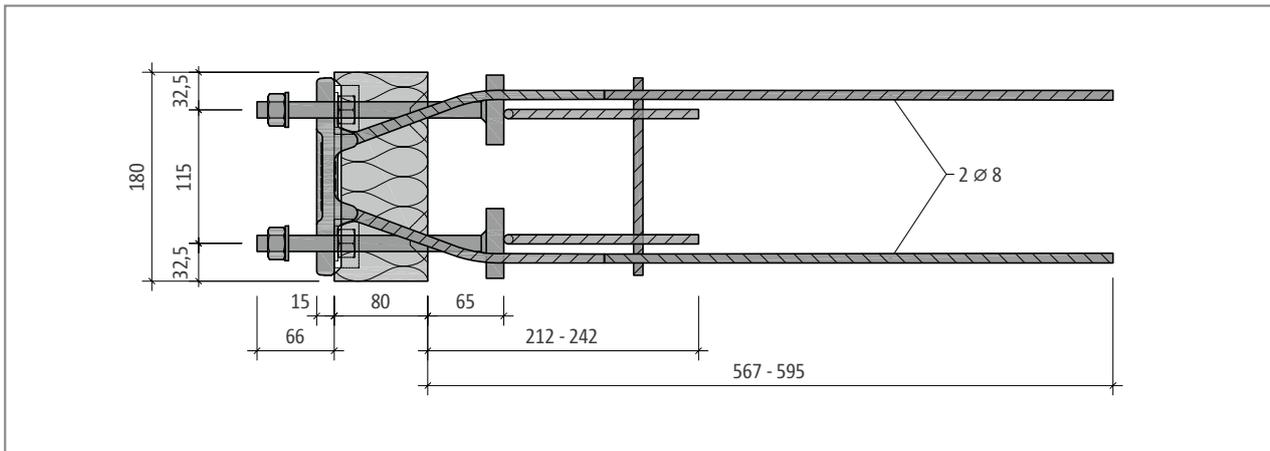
Schöck Isokorb® T type SQ-V1 : plan de base
